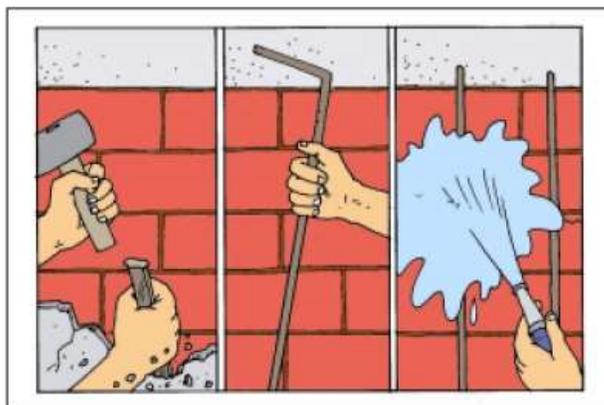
Recomendaciones para el reforzamiento con concreto reforzado (Equipo y Ejecución). Fuente Manual AIS de reforzamiento de viviendas en mampostería
